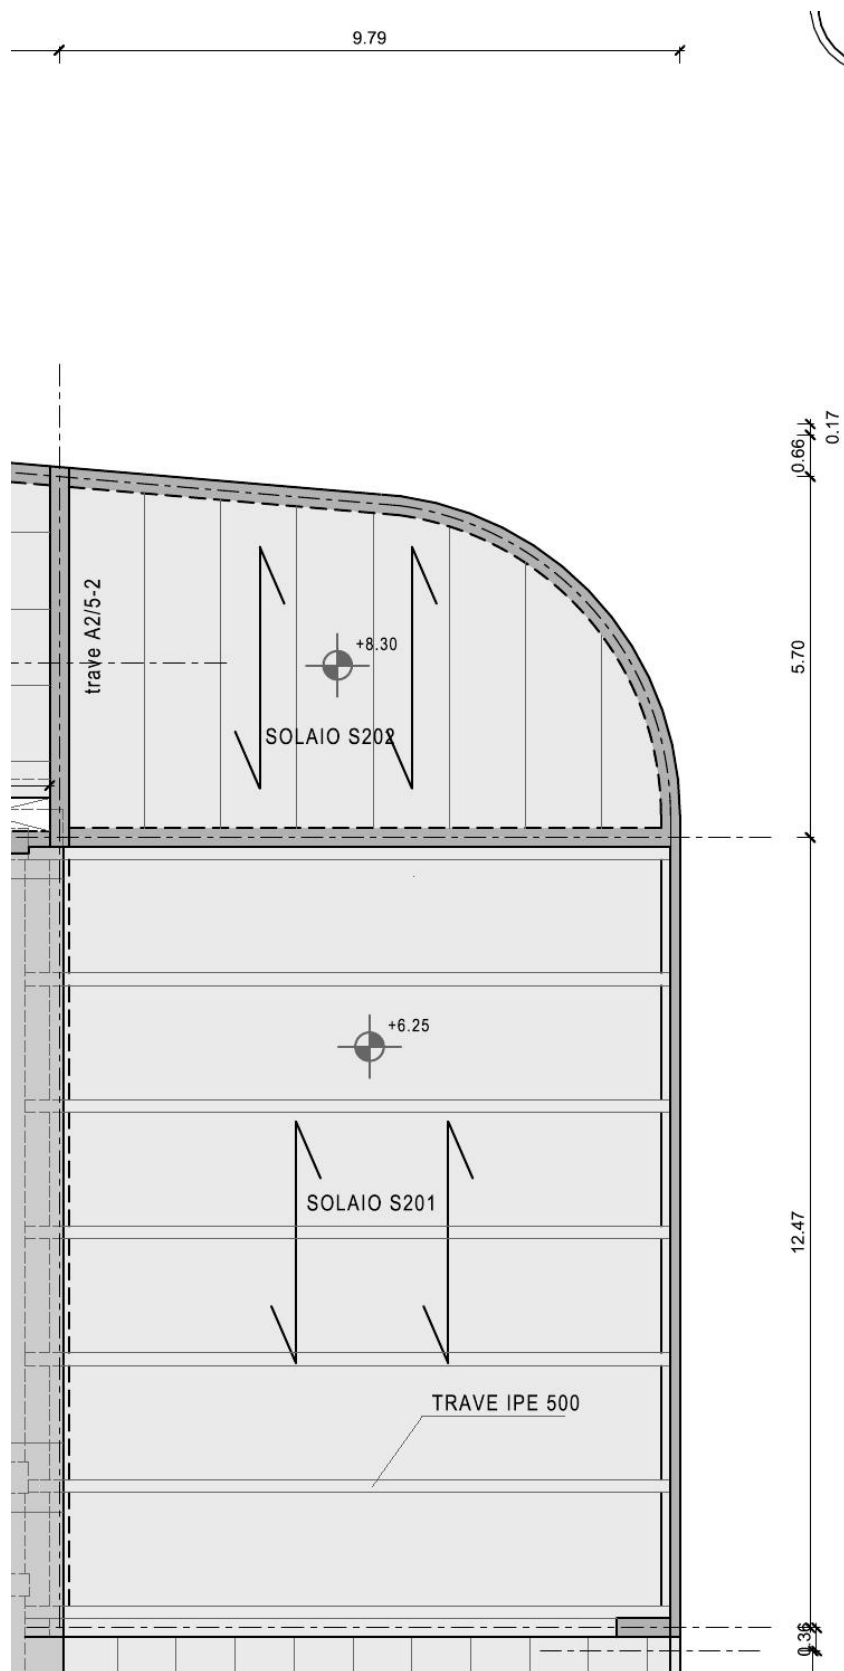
Particolare di A.2003.a.sa.T01 - Pianta copertura
